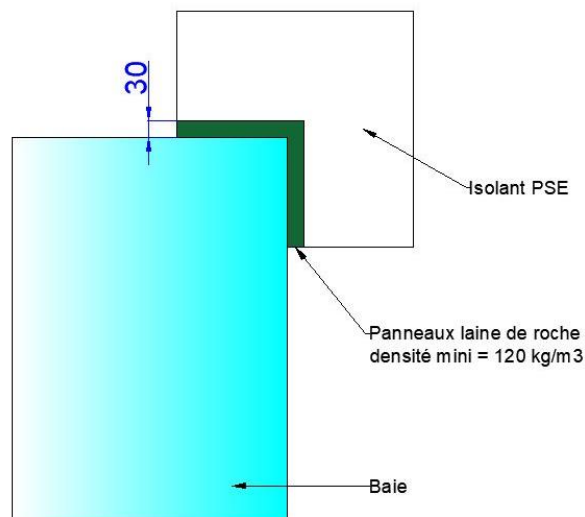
Dispositions pour l'encadrement des baies, découpe en L d'un panneau PSE autour d'une baie
